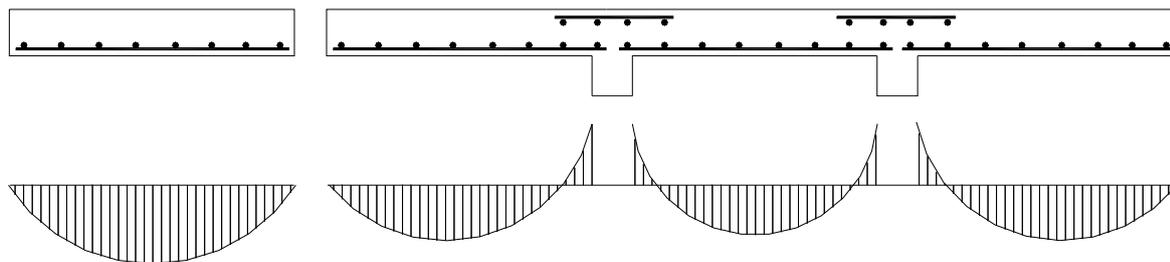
Схемы армирования однопролетной и многопролетной плит
